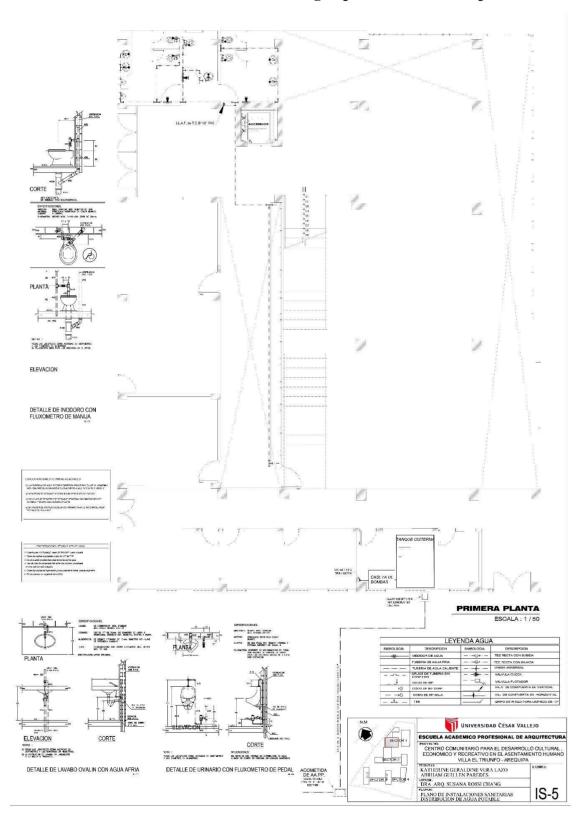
Planos de distribución de redes de agua potable Primera Planta - Elaboración propia
